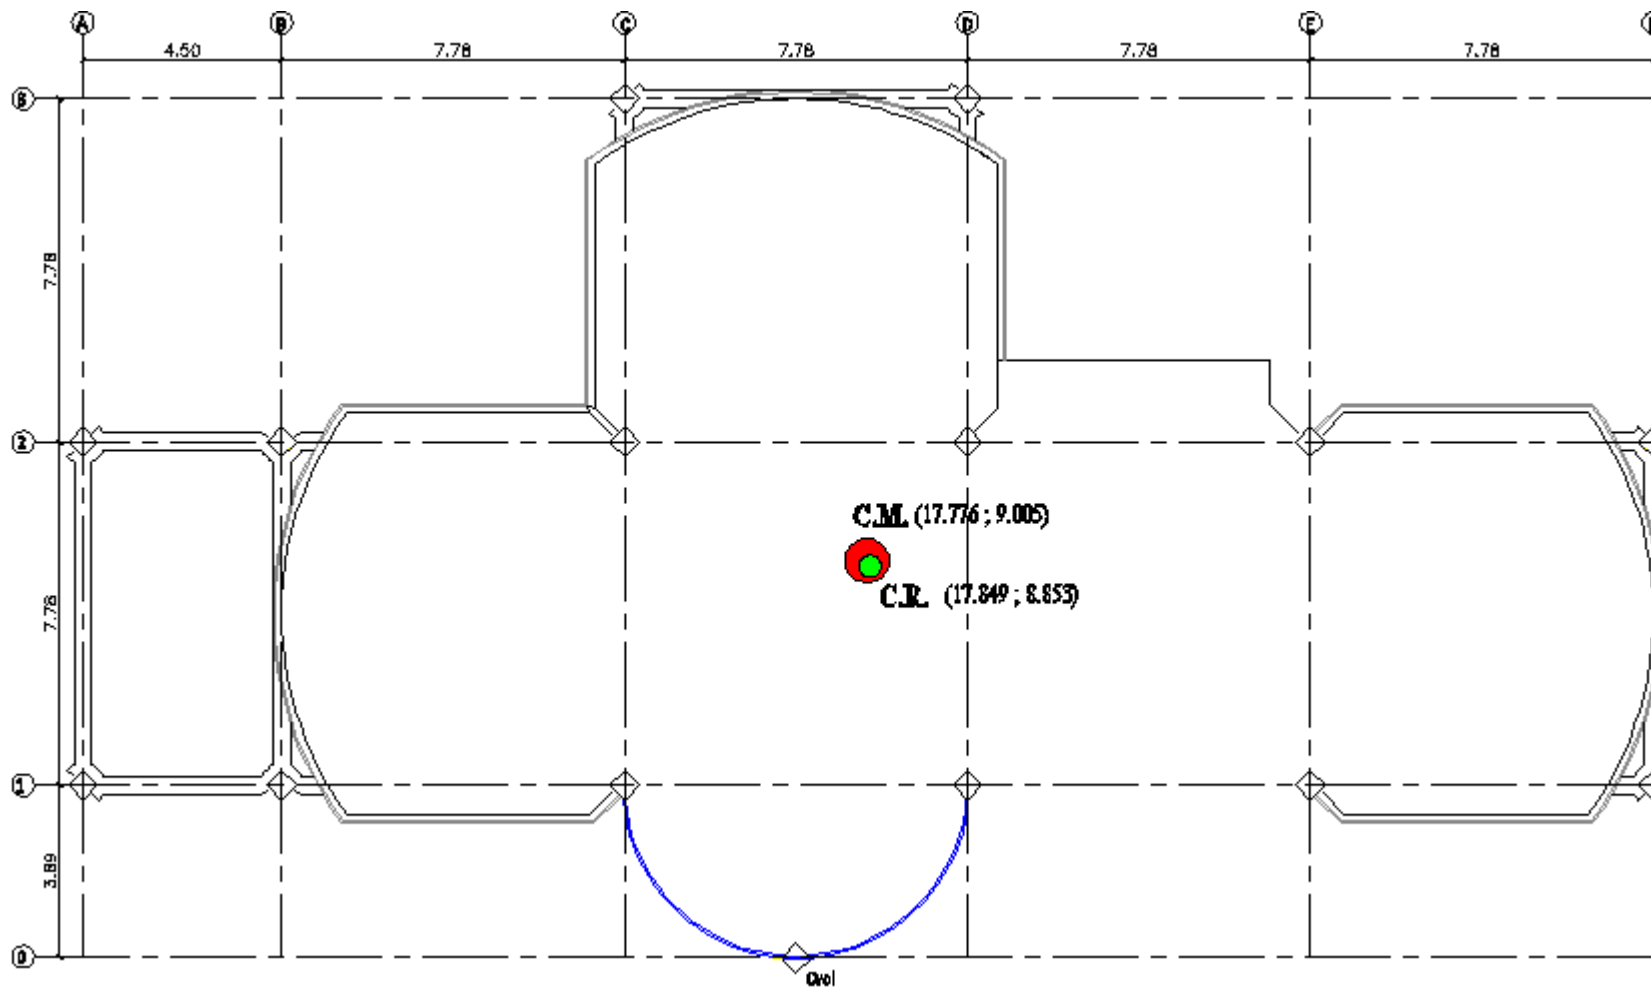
Centro de Masas y Rigidez de las Losas N+3.08
